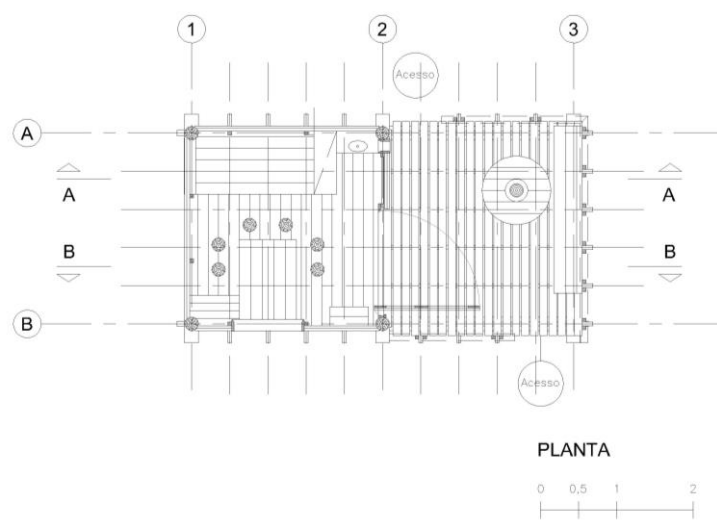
Desenho técnico da planta. Desenho: Alexander Chang.
